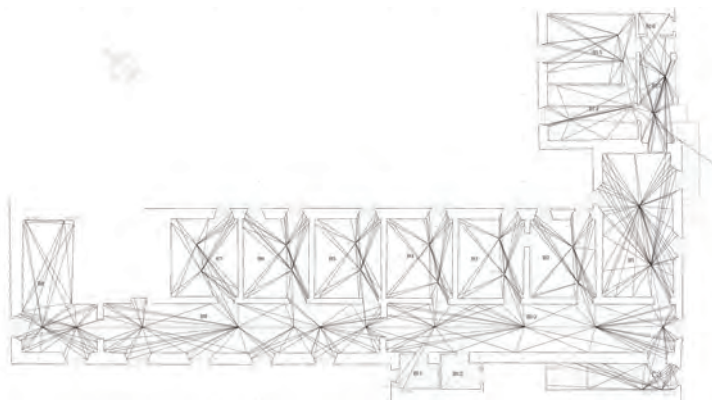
Restituzione del rilievo longimetrico e topografico della pianta del piano primo
